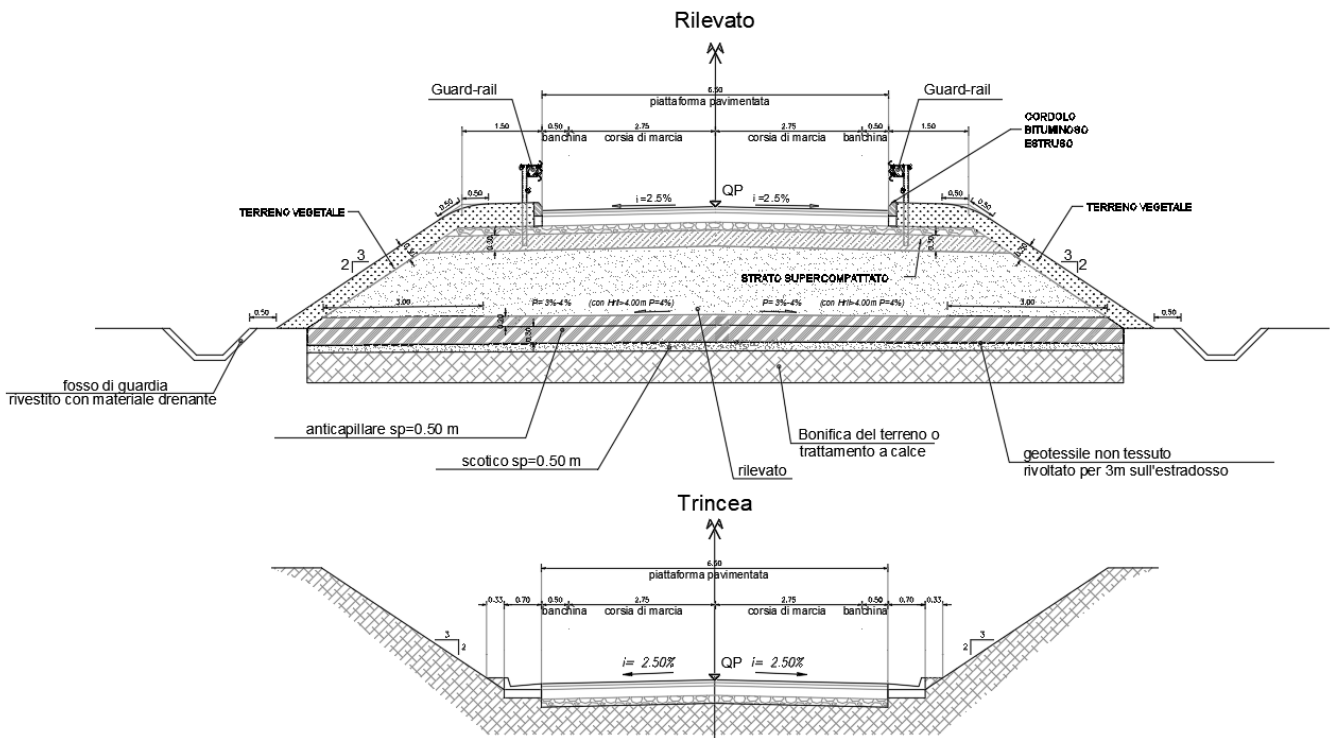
Sezione tipo in rilevato e in trincea (NV08)
